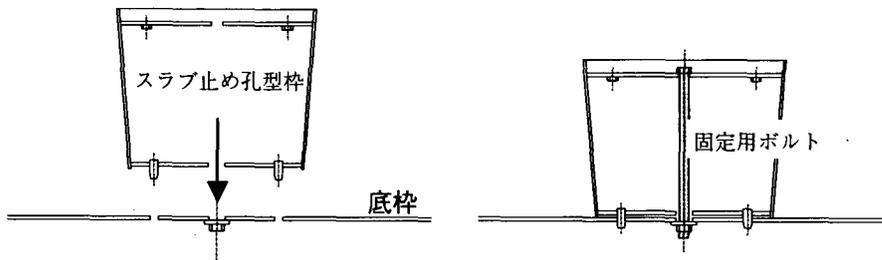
スラブ止め孔型枠の固定方法の例
